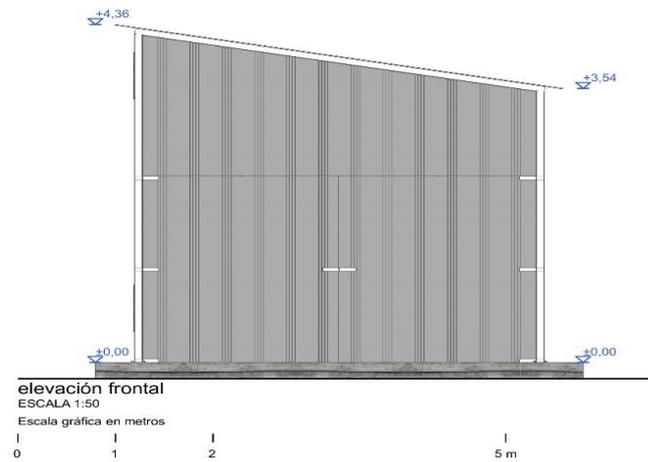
Vista Frontal del secador solar diseñado (Fuente Propia)
